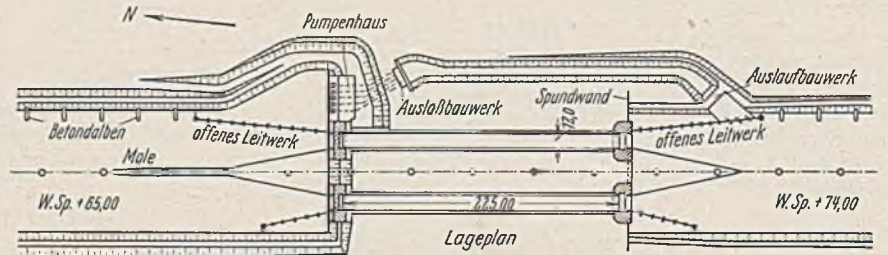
Schleusengruppe Wedtlenstedt. Lageplan.
